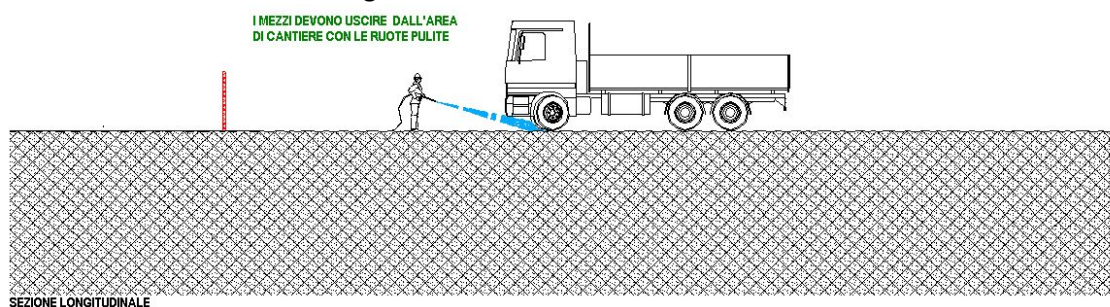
Pulizia ruote dei mezzi, nell'area di cantiere
